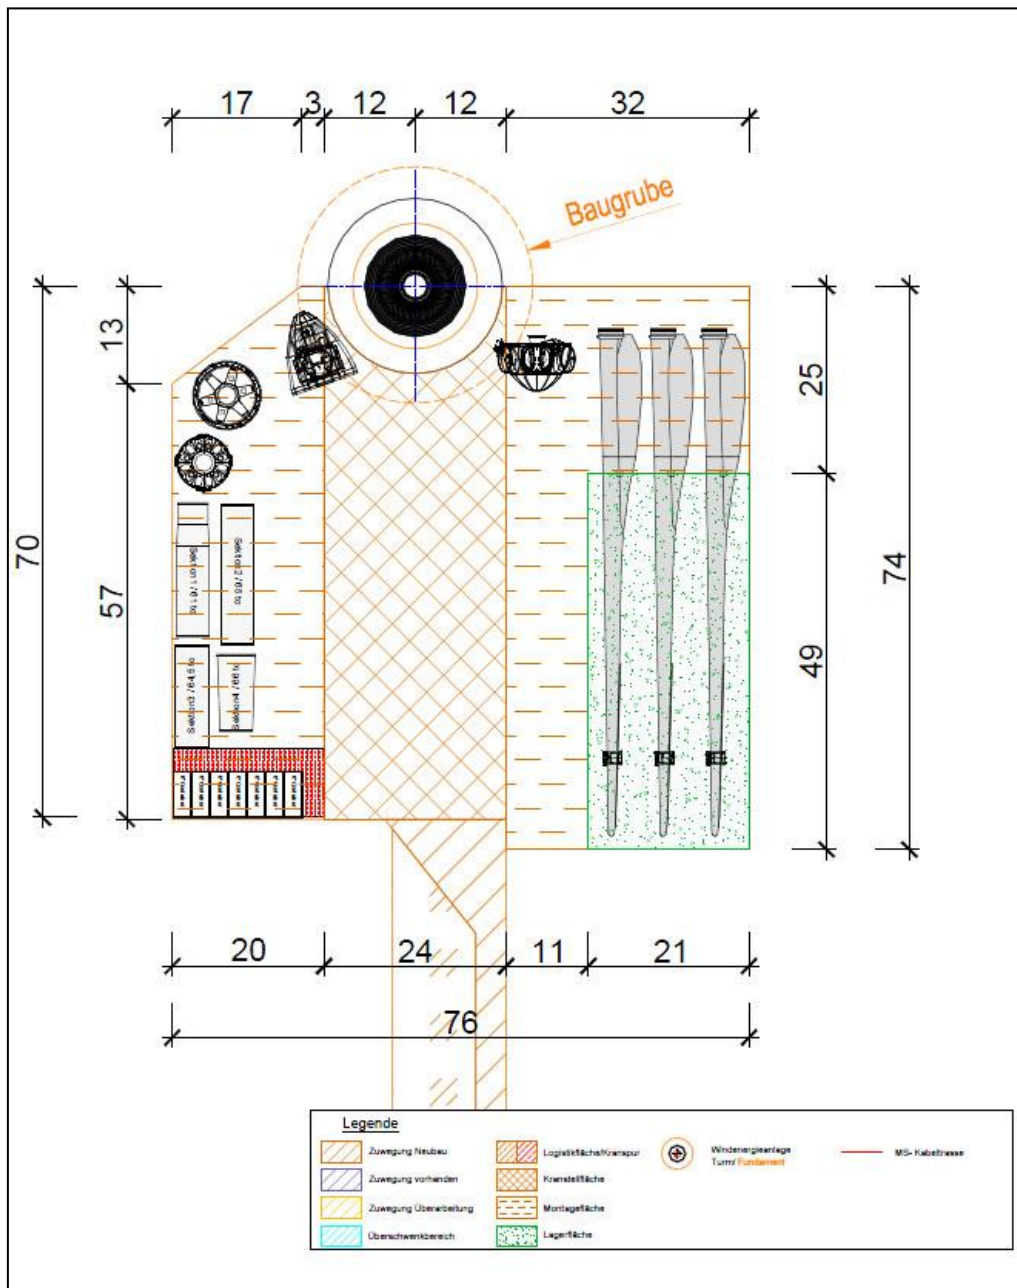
Beispiel-Lageplan der geplanten WEA (E-141)
